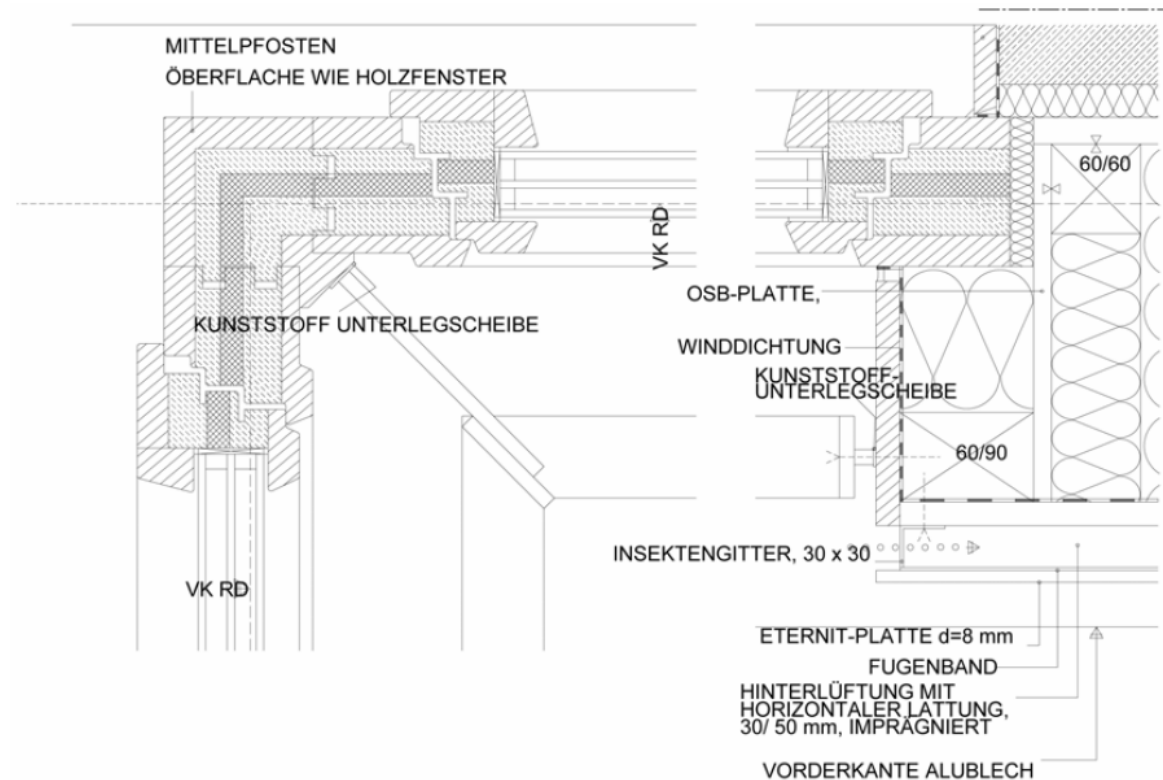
Fensterdetail Grundriss PH [Quelle: ACMS]
